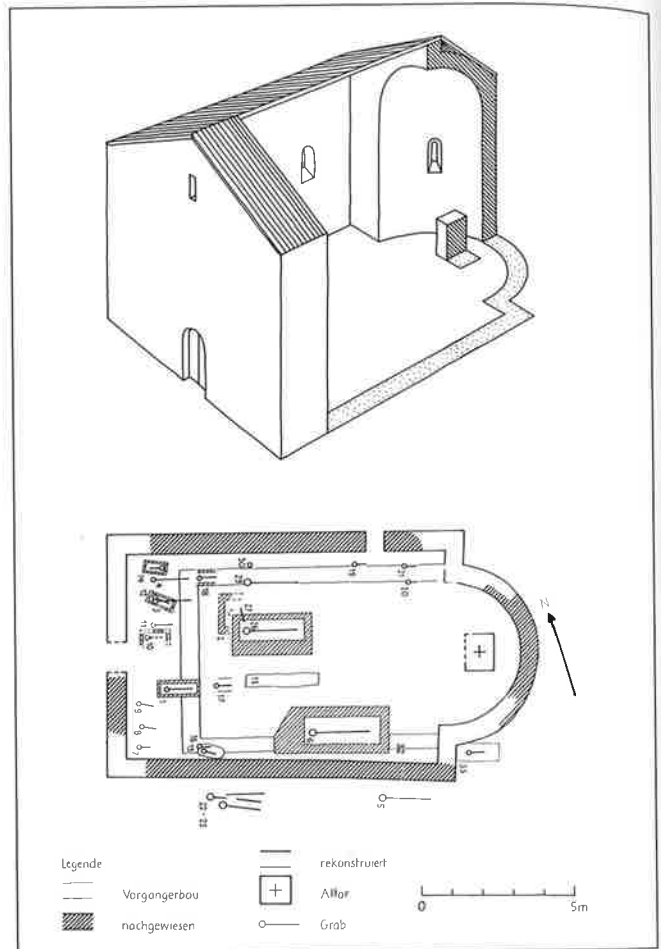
Stein am Rhein. Kirche Burg. Grundriss und Rekonstruktion der Kirche mit eingezogener Apsis (Bau II.2). M 1:250.
